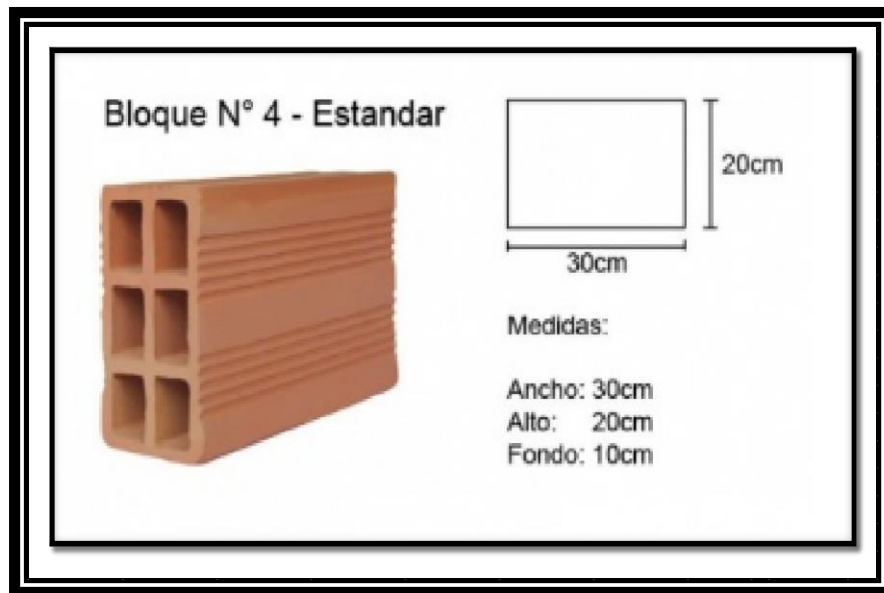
Ejemplo, tipo de mampostería utilizada en la obra
